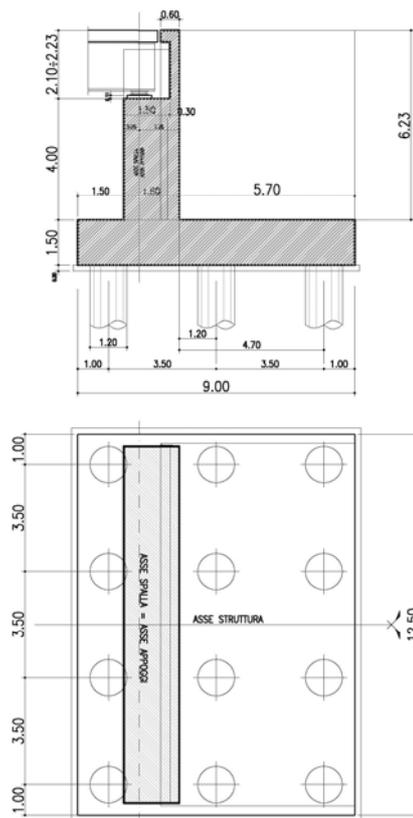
Pile 5 e 6: sezioni e pianta
